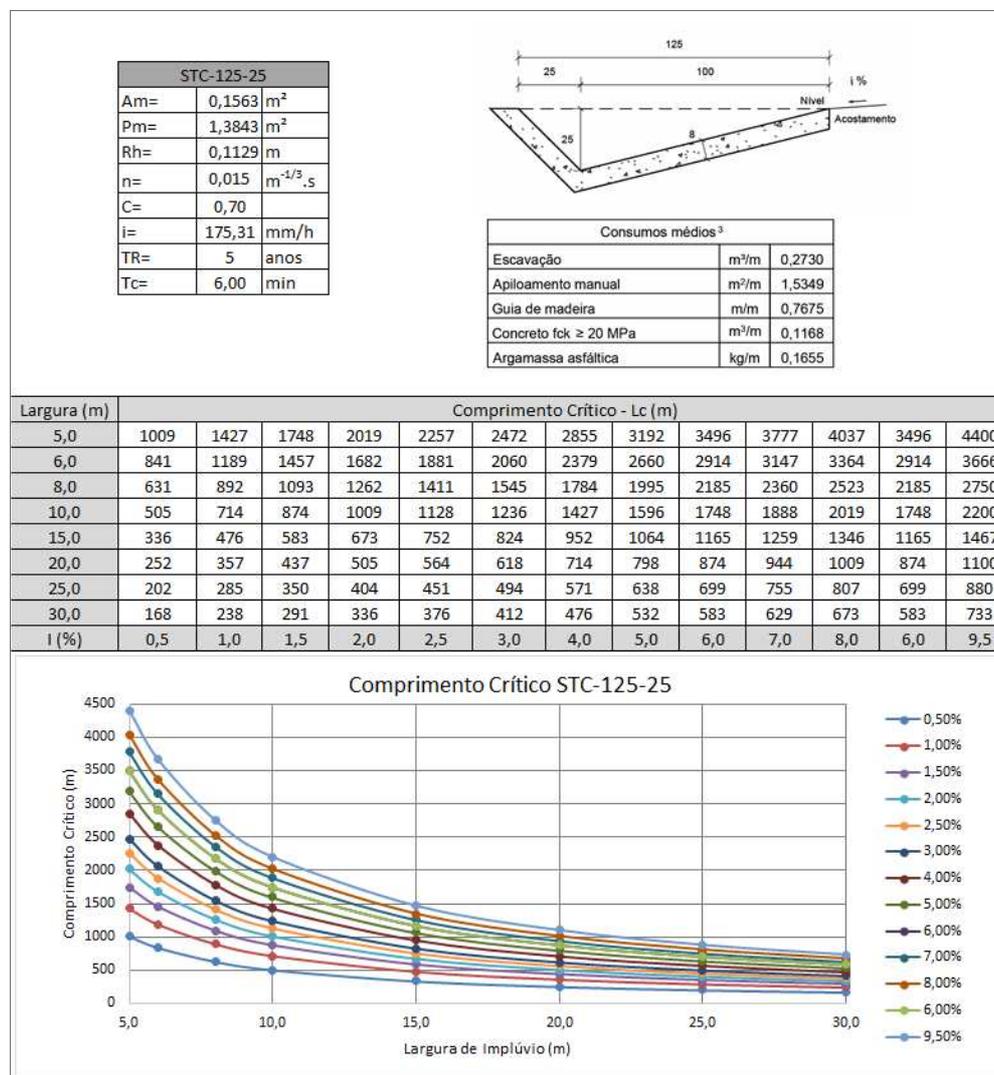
Comprimento Crítico de Sarjeta de Corte em Concreto - STC-125-25
